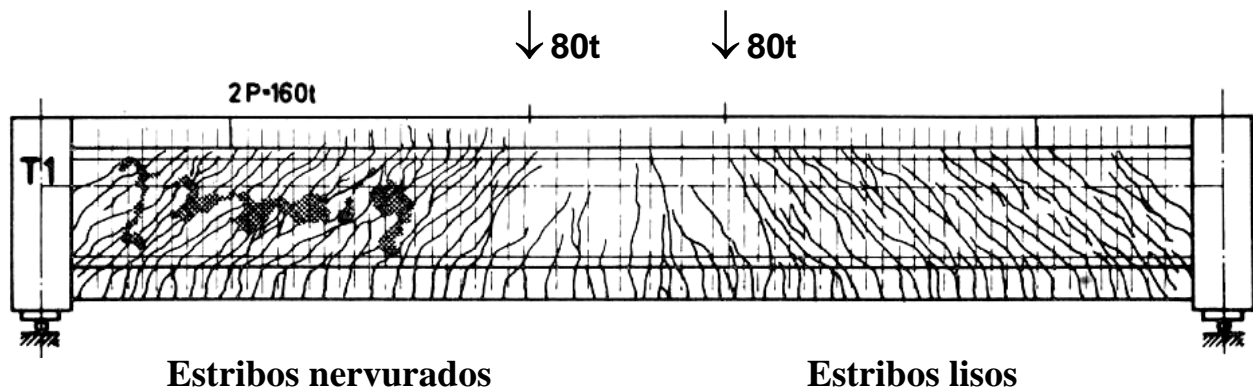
Fissuração para a carga total de 160t = 1600kN
